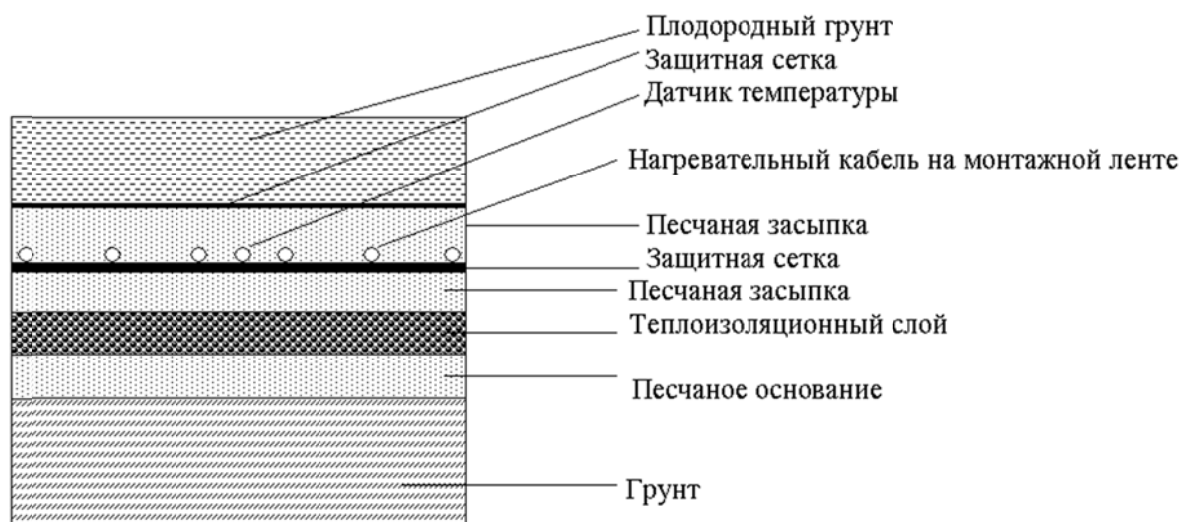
Схема укладки нагревательных секций в траншее при монтаже
